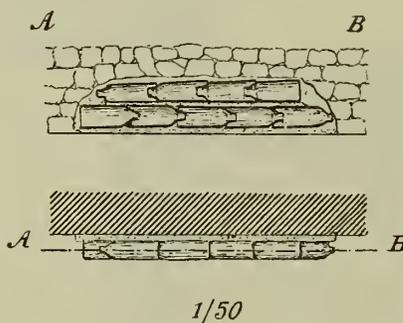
Auf- und Grundriss der Ostwand im Raume 10 der Bäder mit eingebauten Heizröhreneihen.
